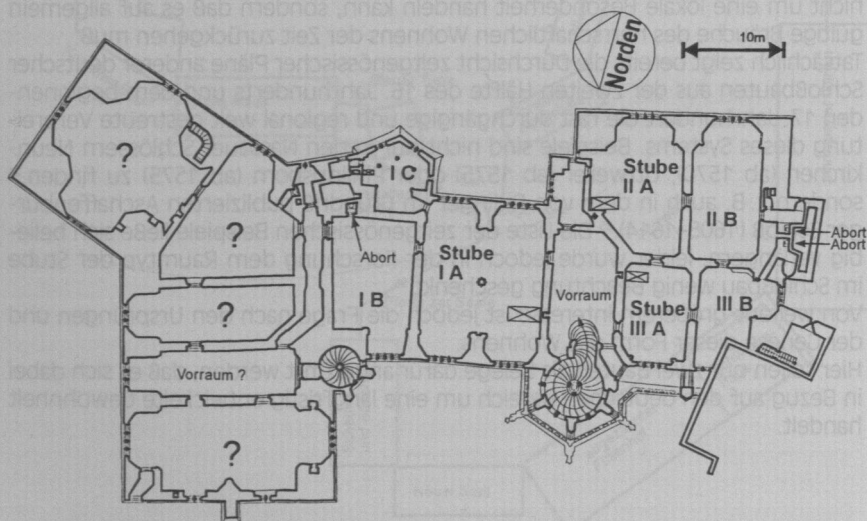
Meißen, Albrechtsburg. Grundriß des zweiten Obergeschosses. Schemazeichnung
